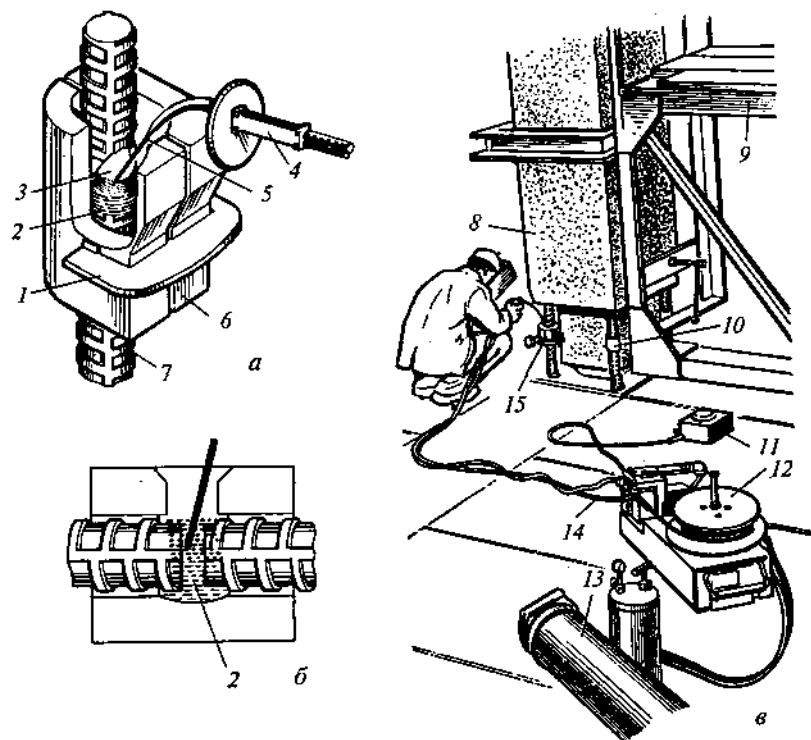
Полуавтоматическая сварка арматурных стыков: а, б — ванная сварка вертикальных и горизонтальных стыков; в — сварка в среде защитного газа; 1 — скоба; 2 — шлаковая ванна; 3 — стык; 4 — держатель; 5 — электродная проволока; 6 — полуформы; 7 — арматура; 8 — колонна; 9 — кондуктор; 10 — сваренный стык; 11 — реостат; 12 — катушка со сварочной проволокой; 13 — баллон с газом; 14 — шланг; 15 — свариваемый стык
